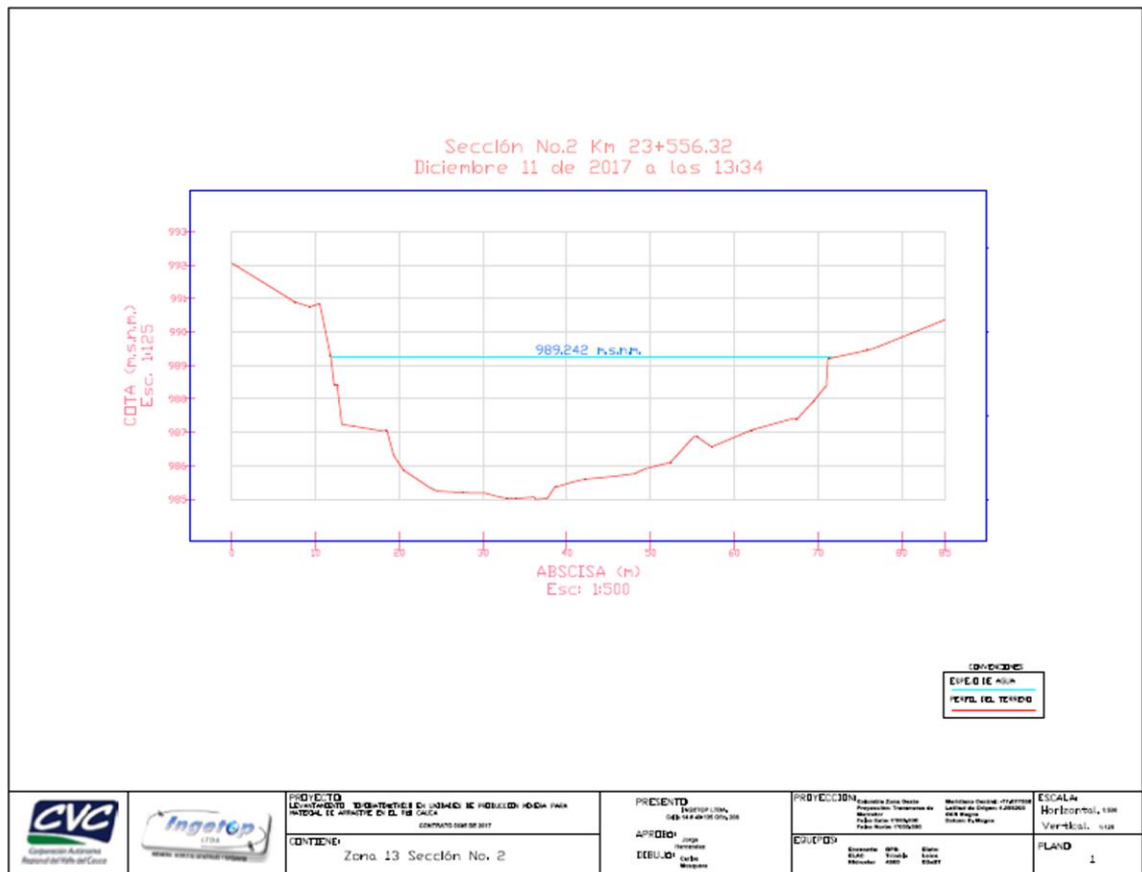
Perfil sobre el río Cauca Cortesía Ingetop Ltda.
